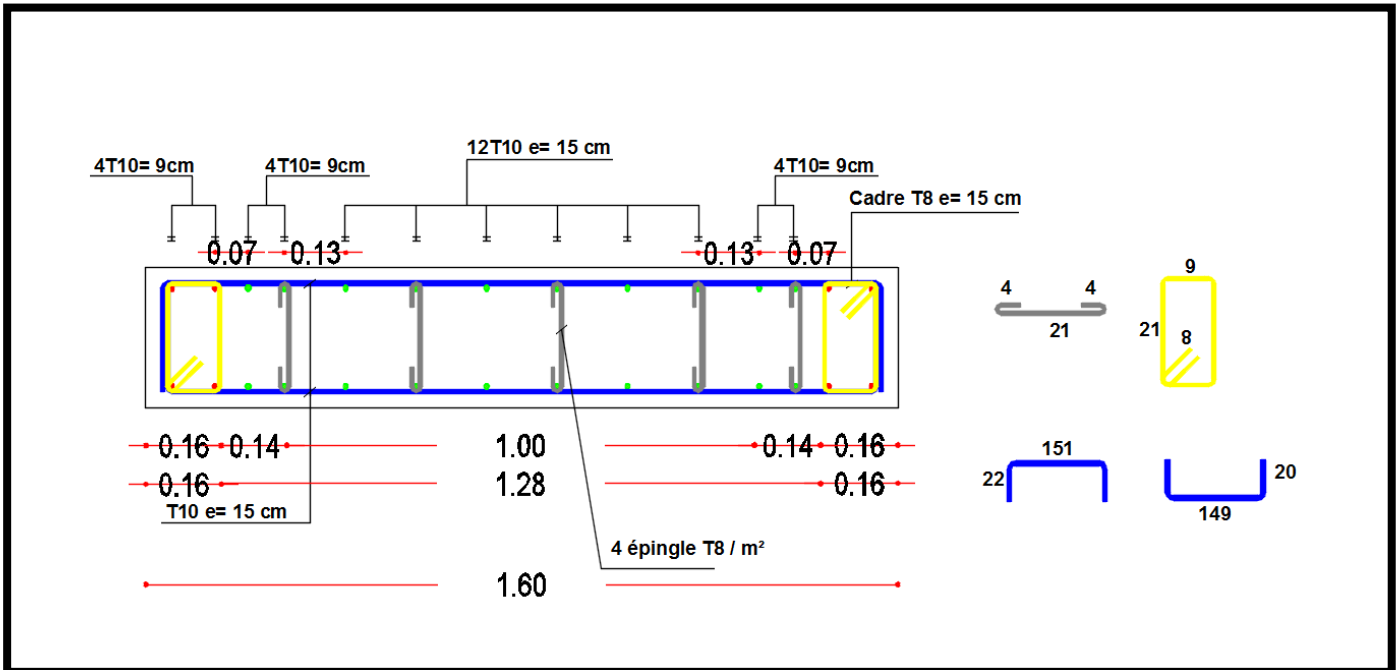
Coupe horizontale du ferrailage des voiles sens Y-Y type (3; 4)
